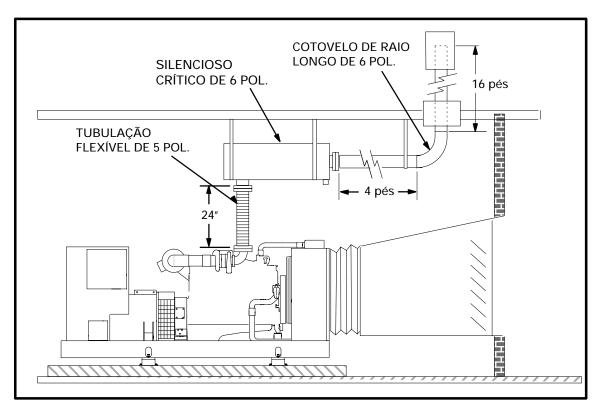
Exemplo de Sistema de Escape para Cálculo
